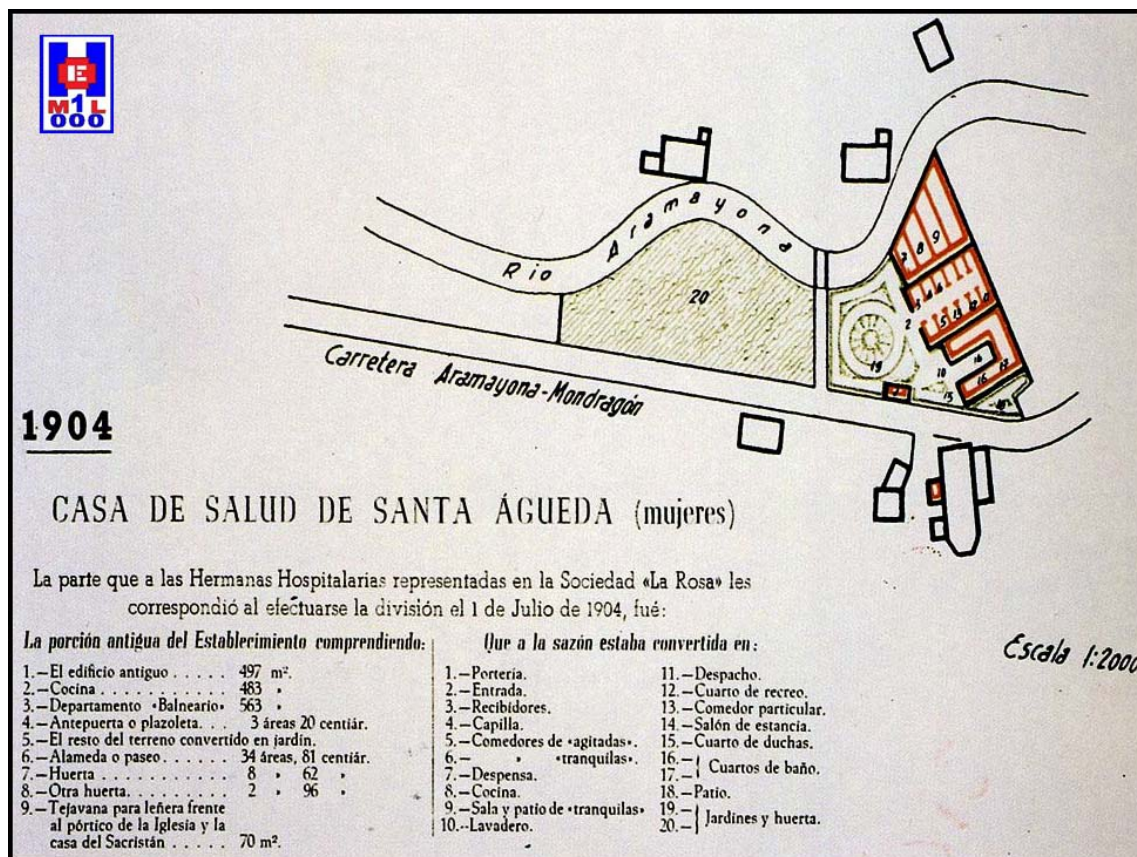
Plano de la Casa de Salud de Santa Águeda, 1904
